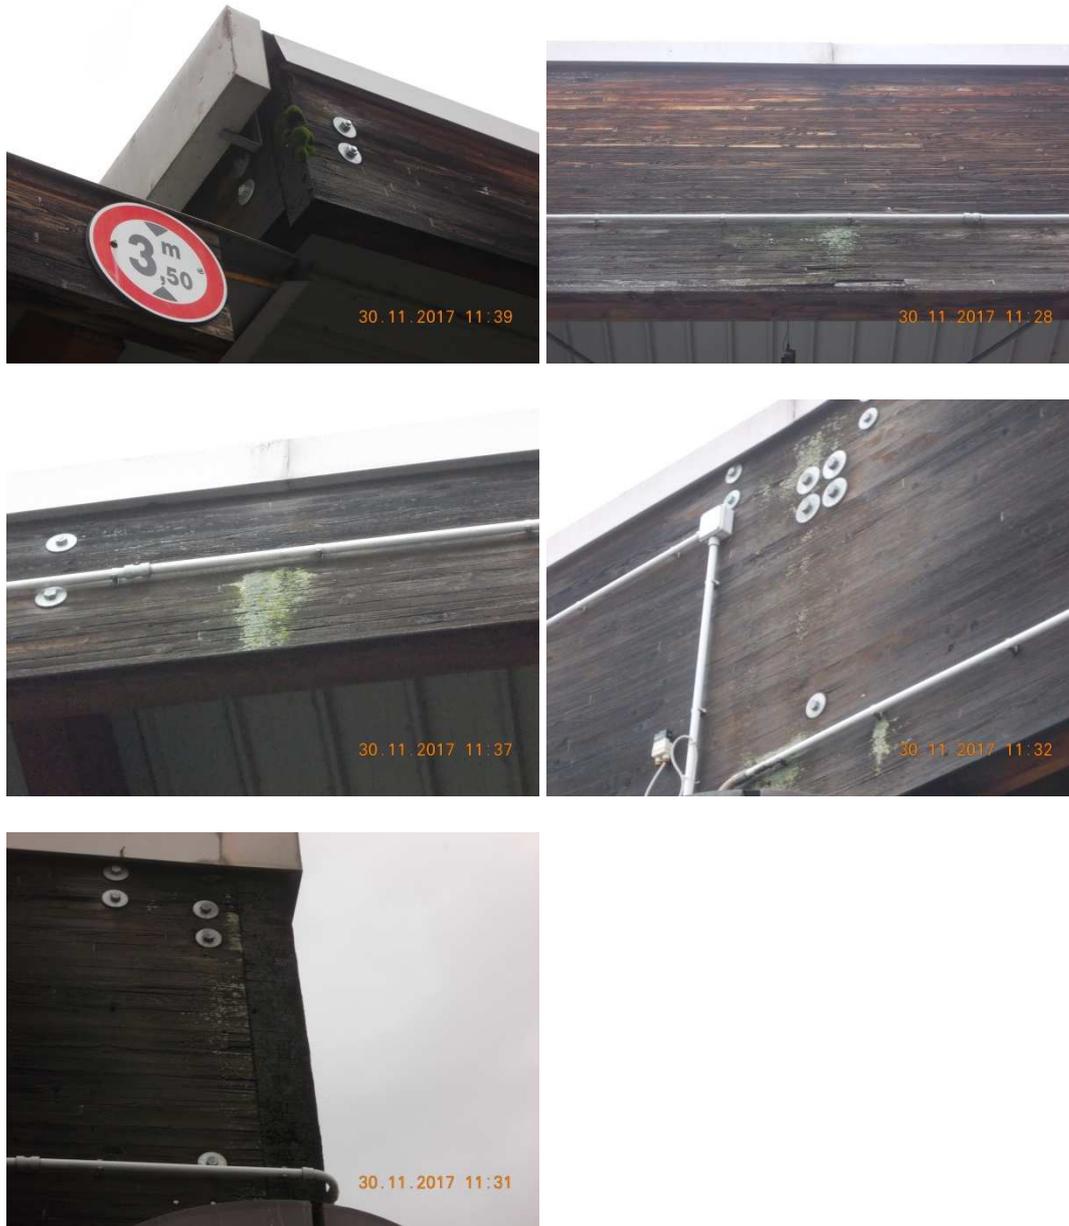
FOTO TRAVE PERIMETRALE PADIGLIONE F6
